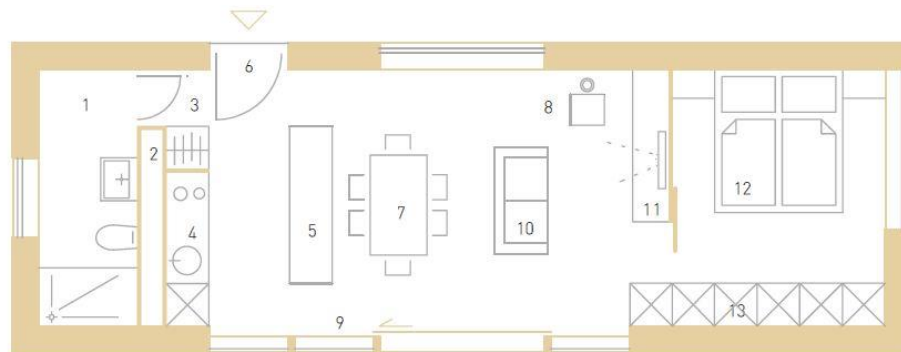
Planta de distribución modelo Su-Si con un área de 30 m² alberga una zona de servicios, estancia y dormitorio (Martinez, 2011).
